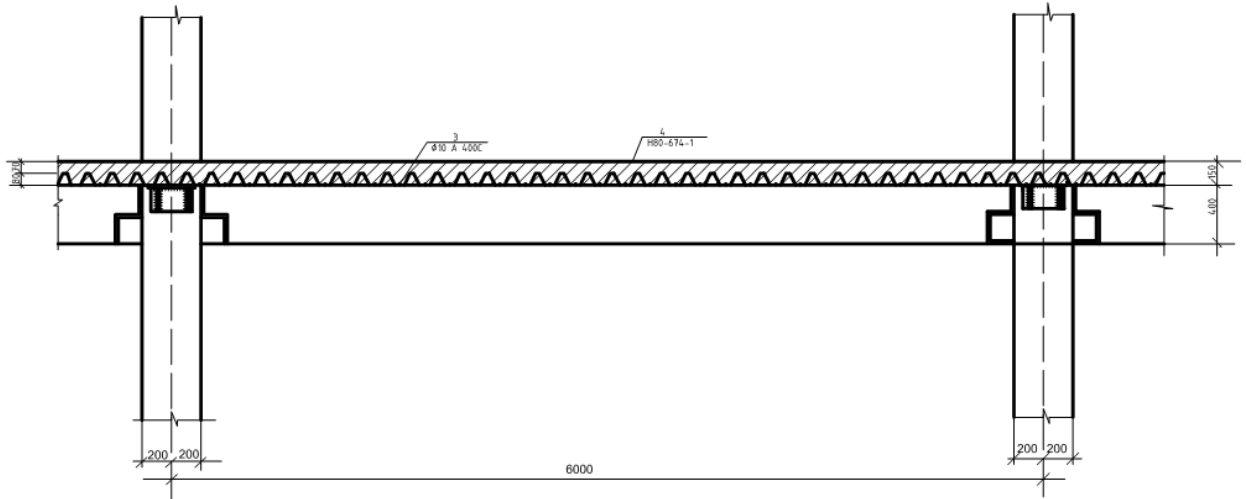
Схема монолітної плити перекриття з арматурою із листової сталі
